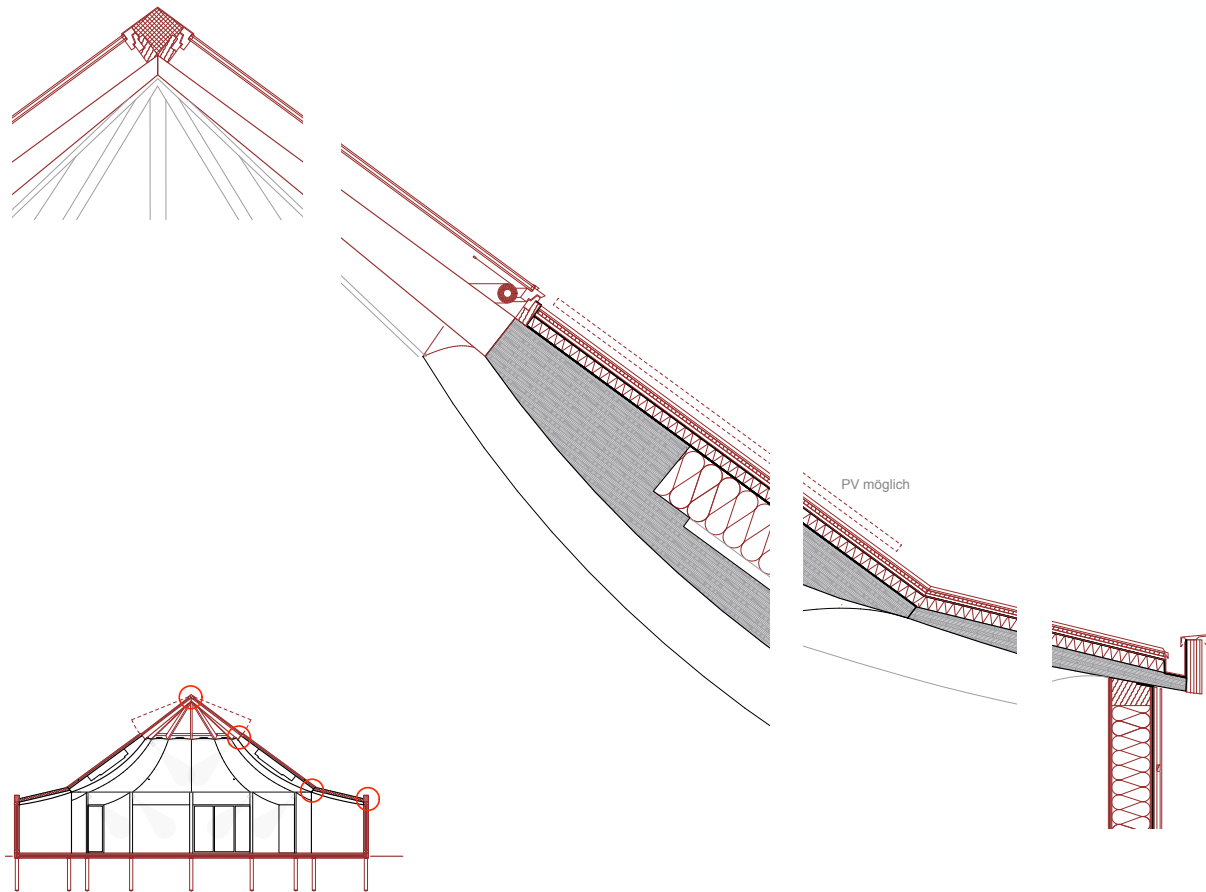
Detailpunkte Firstanschluss, Oberlicht, Elementstoß Dach und Traufanschluss (schwarz: Schalungselemente; rot: ergänzende Bauteile/Konstruktionen), Entwurf HTWG Konstanz
